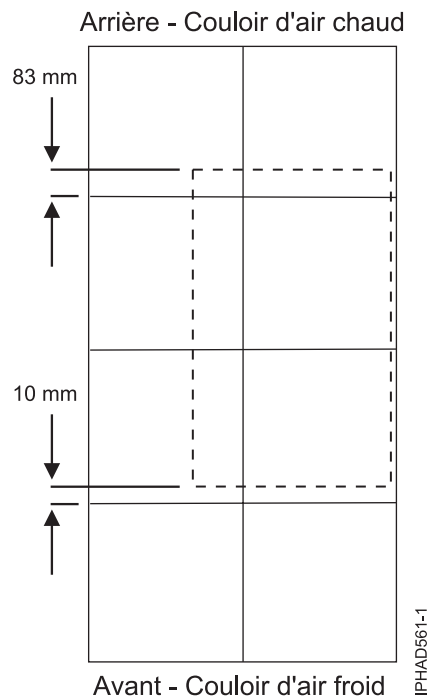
Positionnement de l'armoire pour dalles de 600 mm
